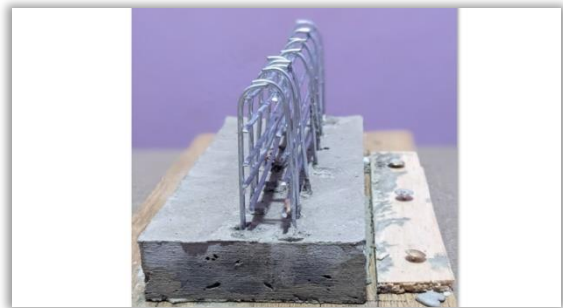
Zapata y armado de acero de cuerpo de estribo
